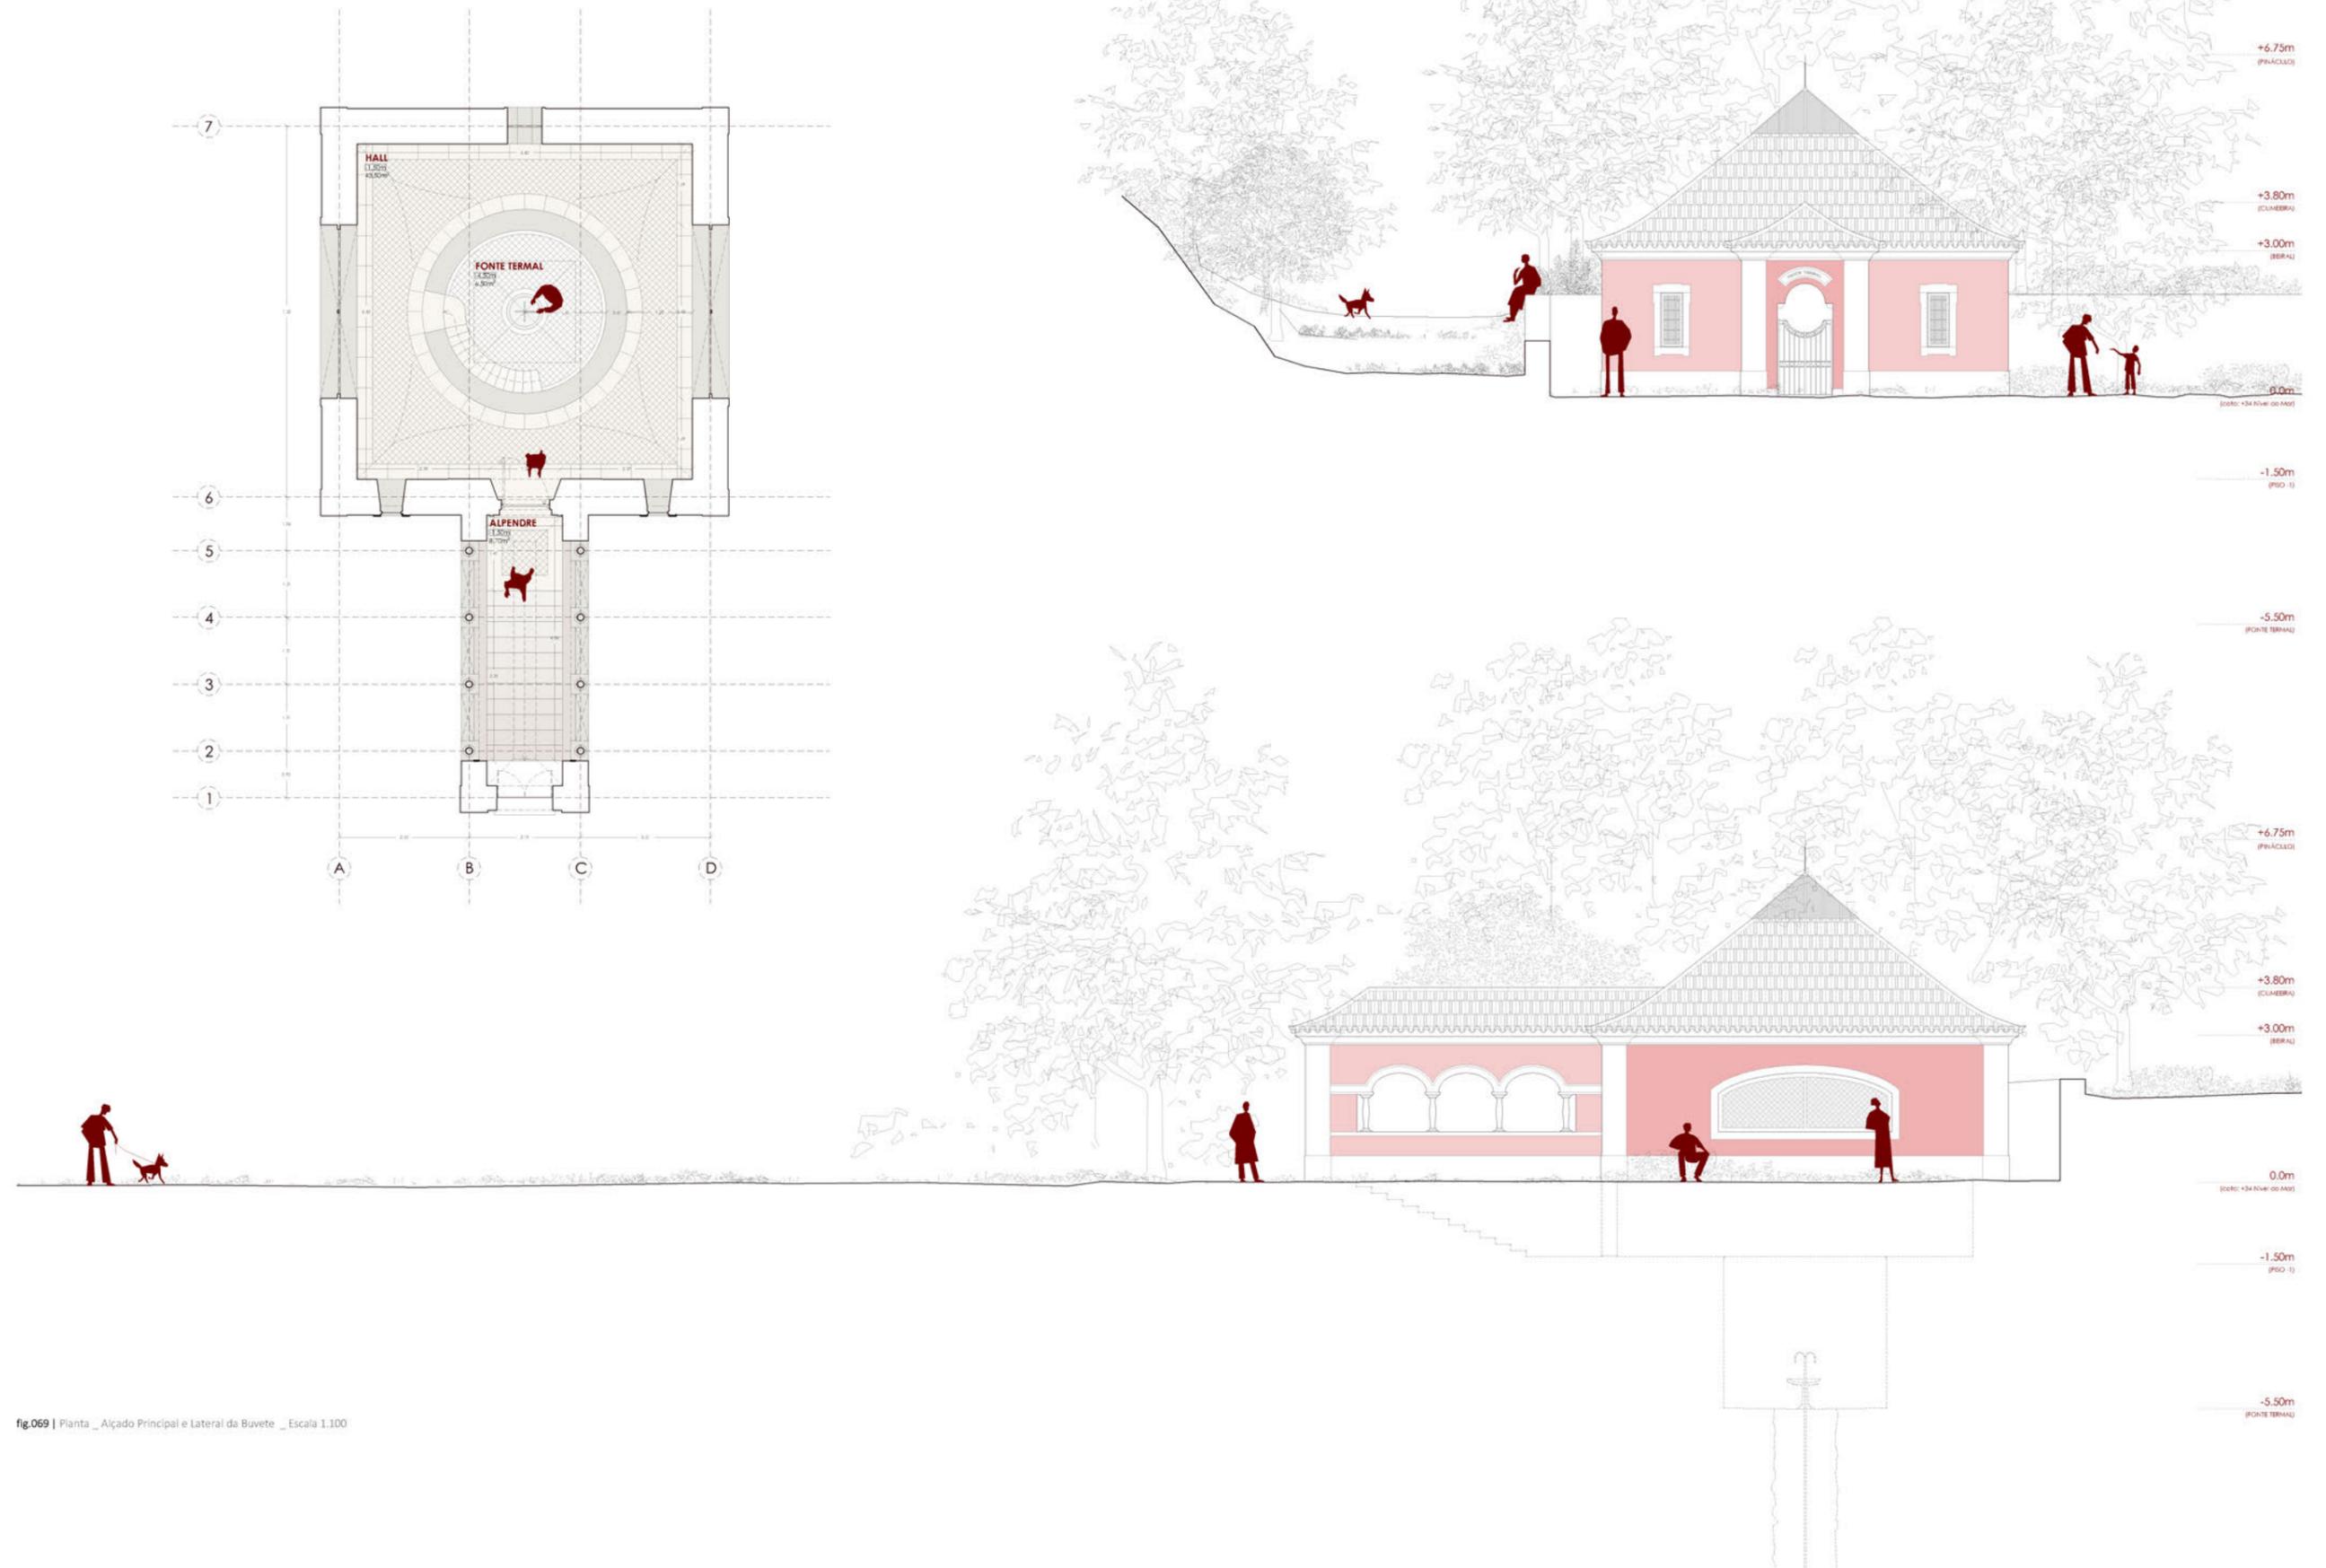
| Planta \_ Alçado Principal e Lateral da Buvette \_ Escala 1.100
